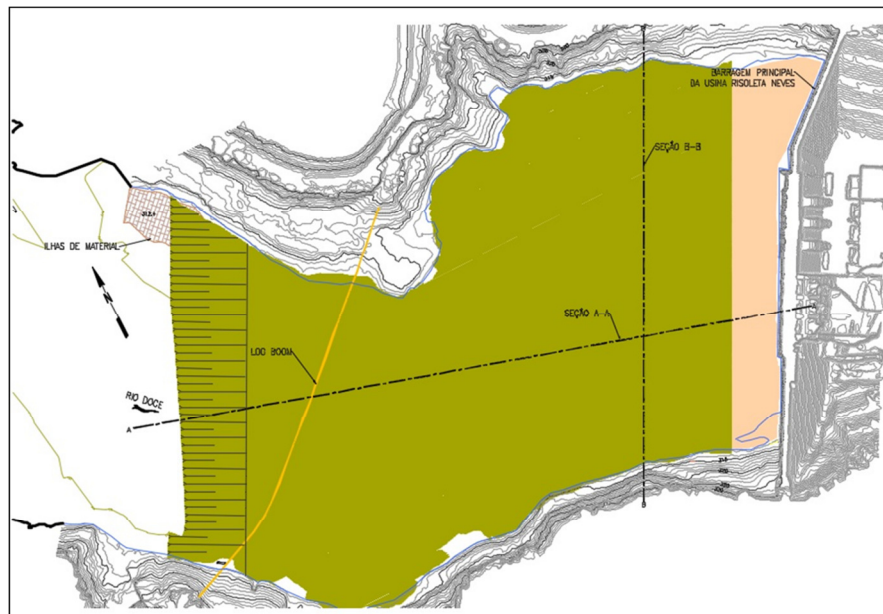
Planta de dragagem EL.308 – Fase 1 - 2a Etapa
